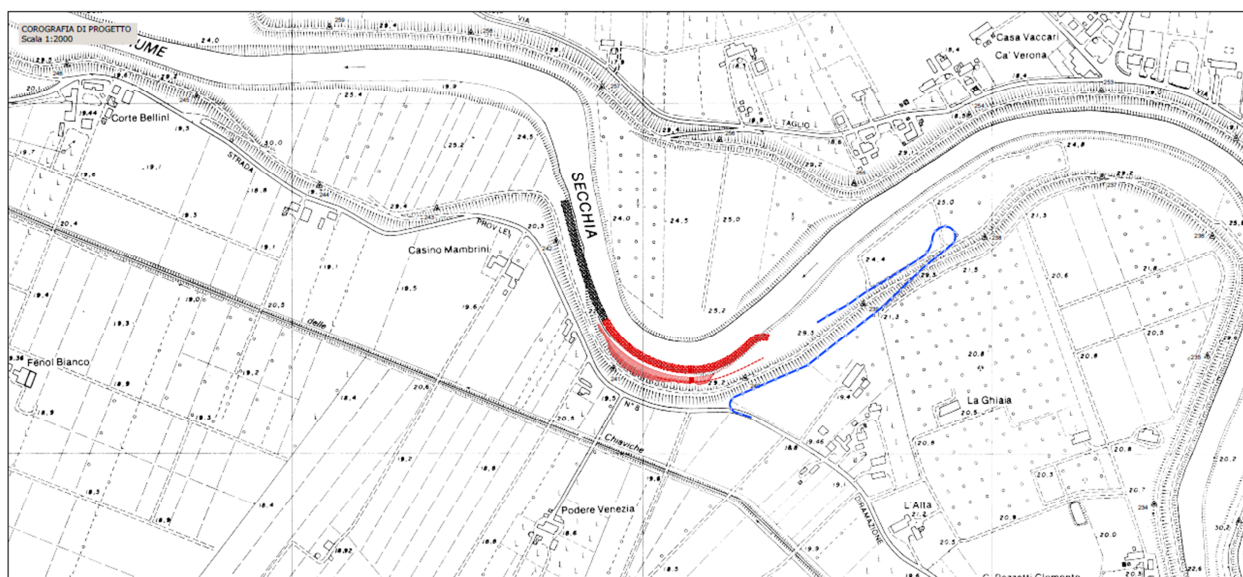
CTR con individuazione della zona di intervento del consolidamento spondale
